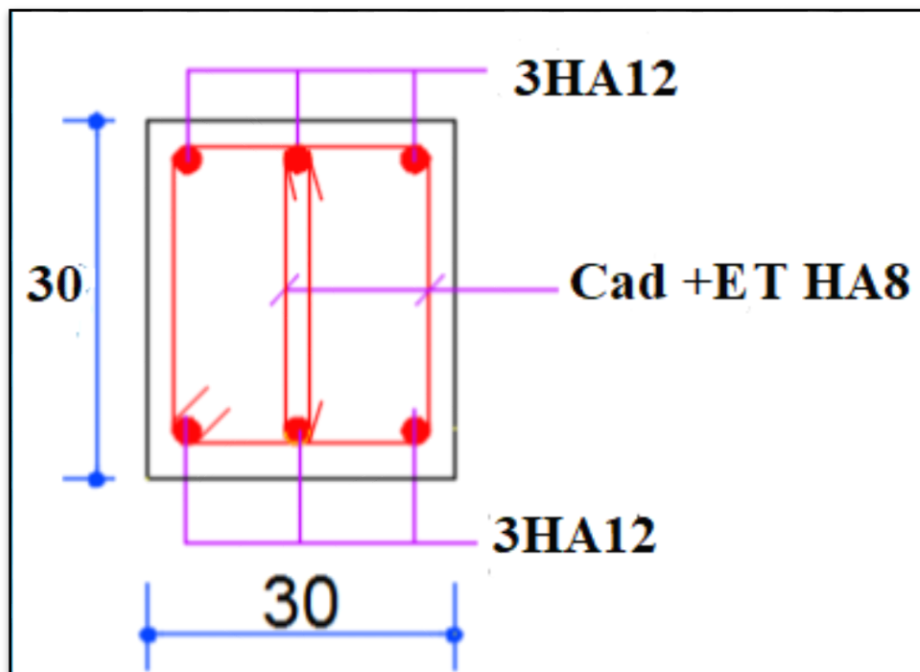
Dessin de ferrailage de poutre palière (appuis et travée)
